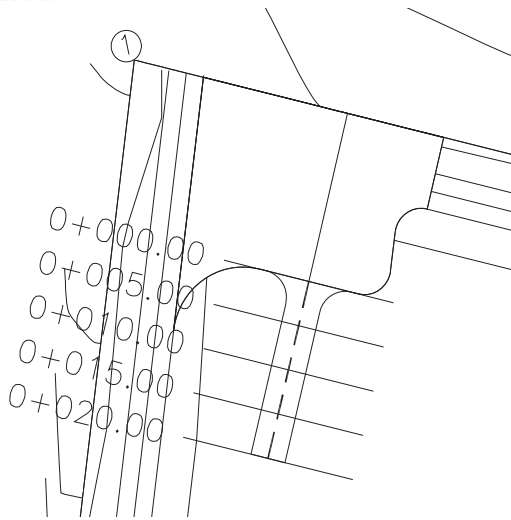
Trazo de las secciones constructivas de la rampa de acceso al nivel de fondo del monorrelleno.
